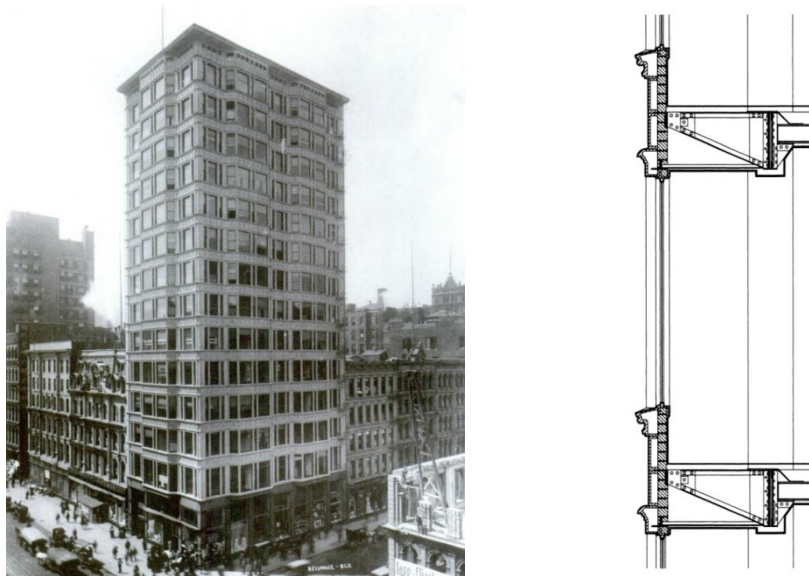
a-Facciata del Reliance Building, Chicago, 1895, tratto da "Contemporary Curtain Wall Architecture", Murray, 2019; b-Sezione esterna muro del Reliance Building, tratto da "Contemporary Curtain Wall Architecture", Murray, 2019
